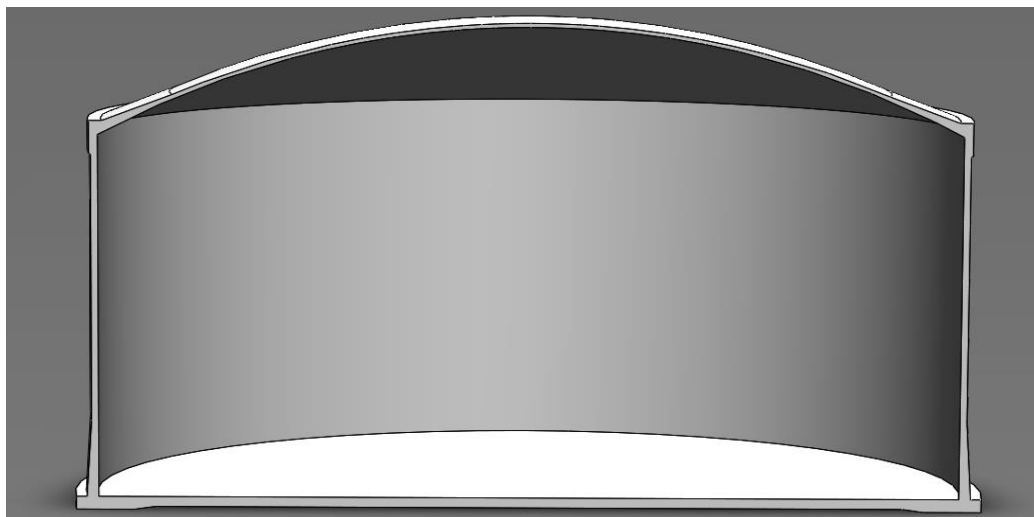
Section verticale du model 3D sans pieux du réservoir en béton
